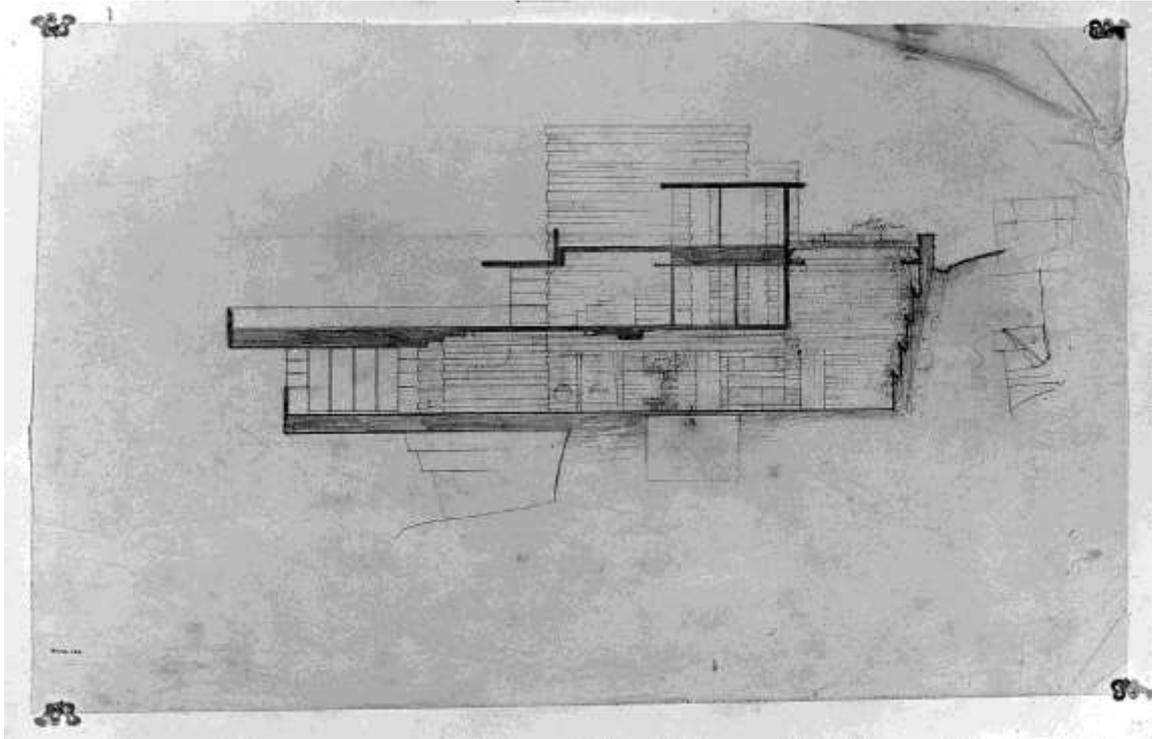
Coupe sud-nord à l'est de la cheminée Columbia FLLW 3602 p. 102
